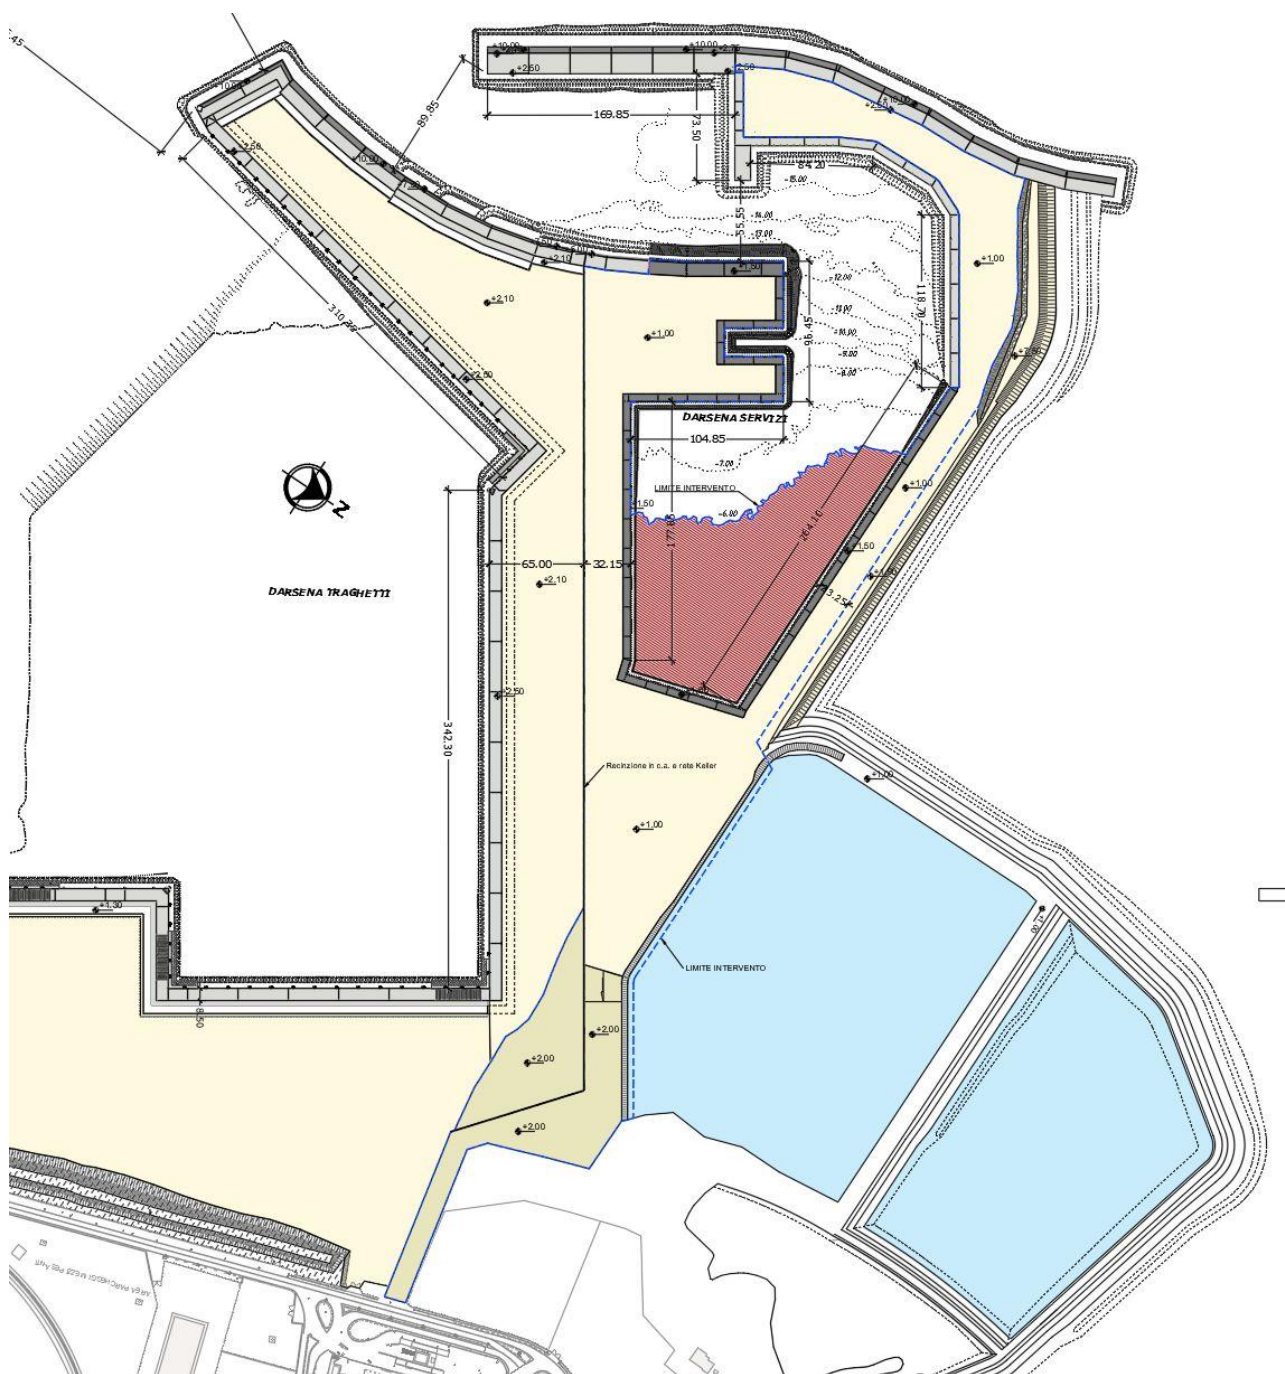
Darsena Servizi: Planimetria delle opere di banchinamento interno e dell'area di dragaggio
